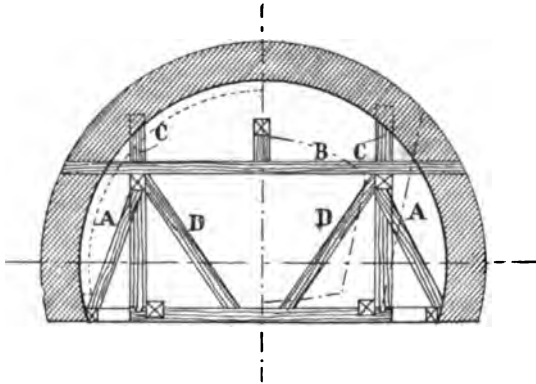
Vue arrière de la dernière ferme d'appui.
